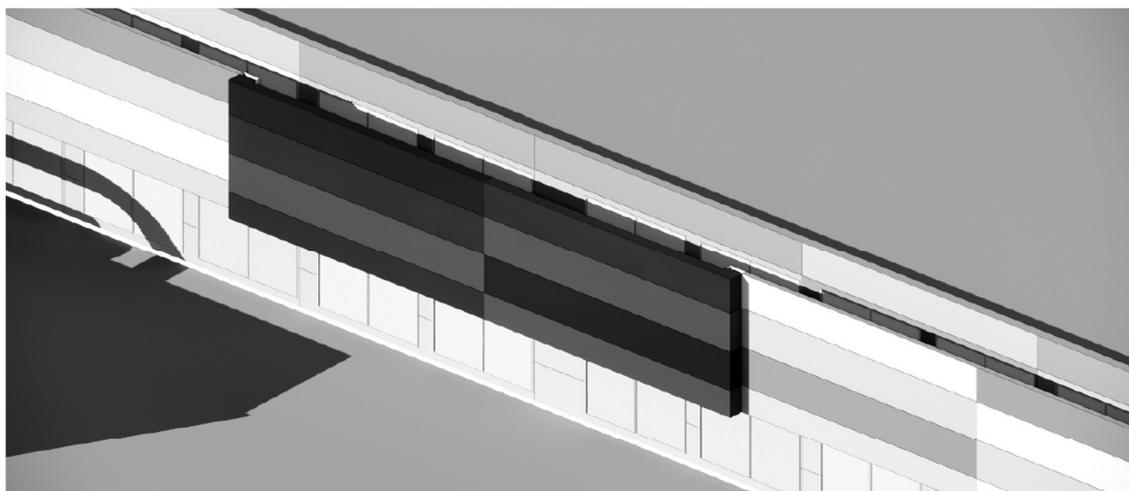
Concetto di suddivisione delle facciate – stralcio vista assometrica
